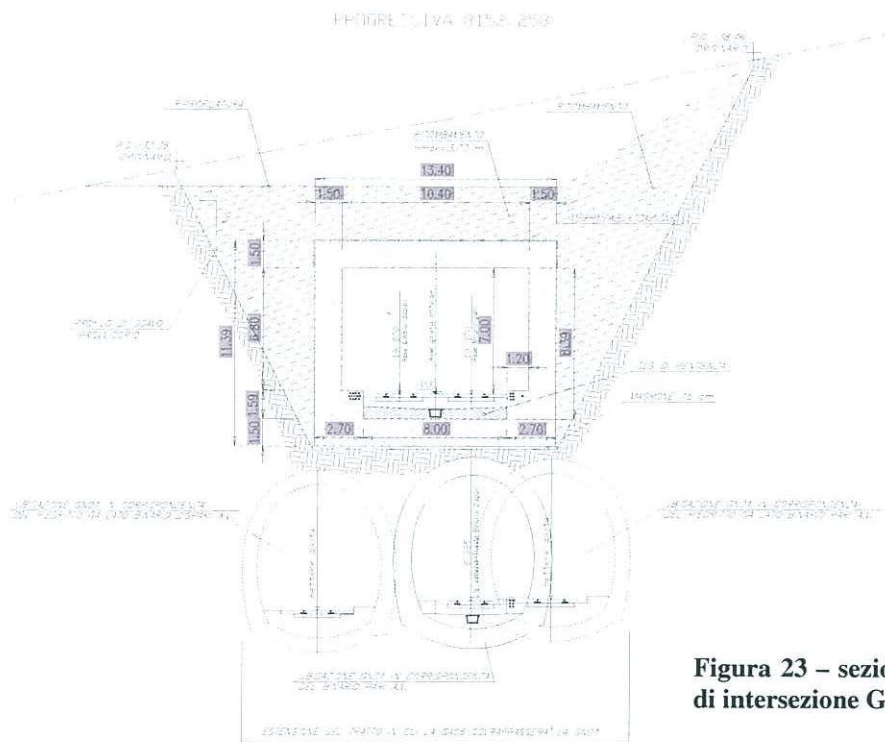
sezione nel tratto di intersezione GA05 – GN01.
